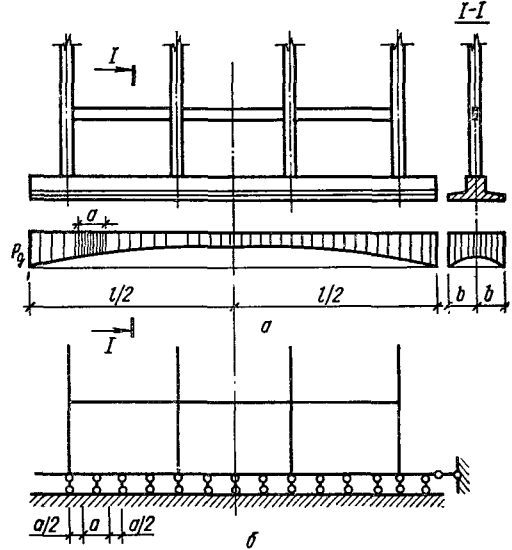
К расчету ленточного фундамента с учетом сопротивления изгибу надфундаментных конструкций:
